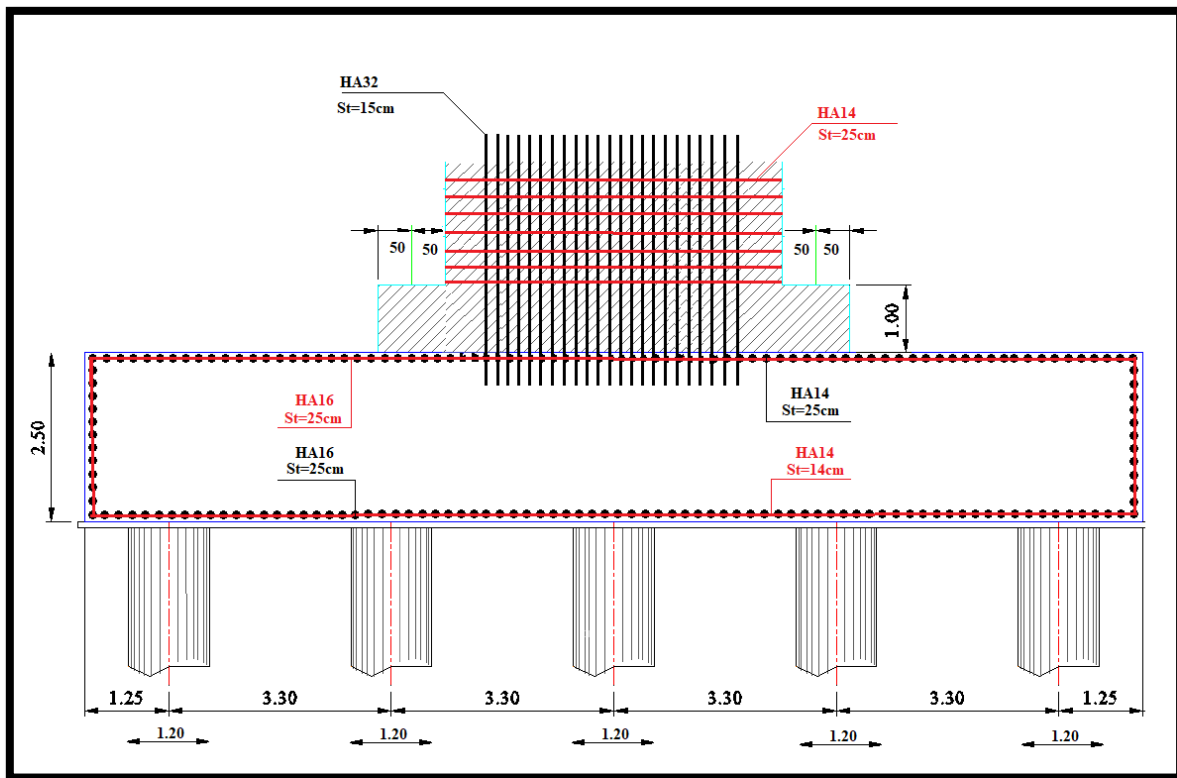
Ferrailage de la pile P2 et sa semelle.
